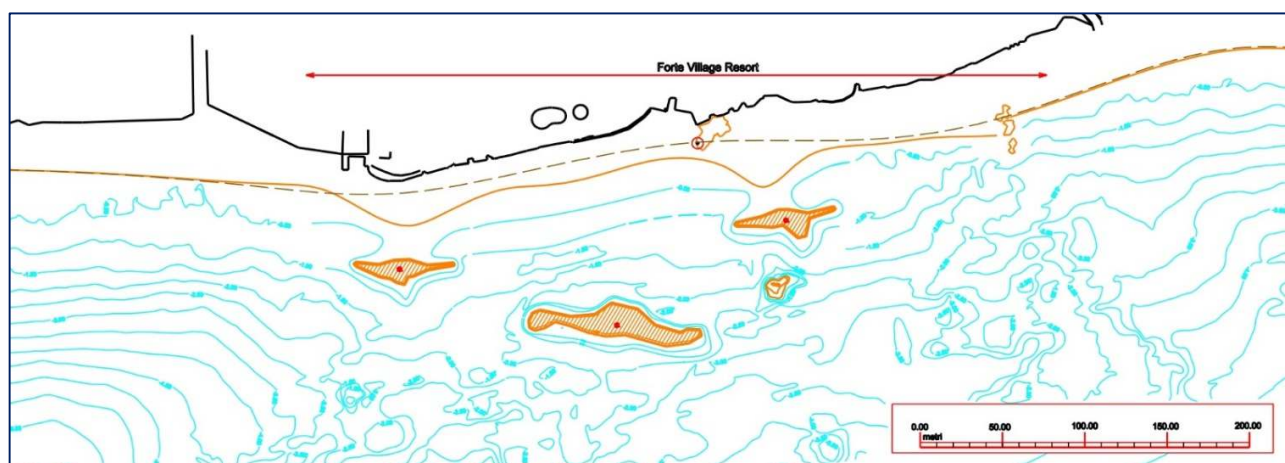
Schema planimetrico dimensionale delle opere in progetto
